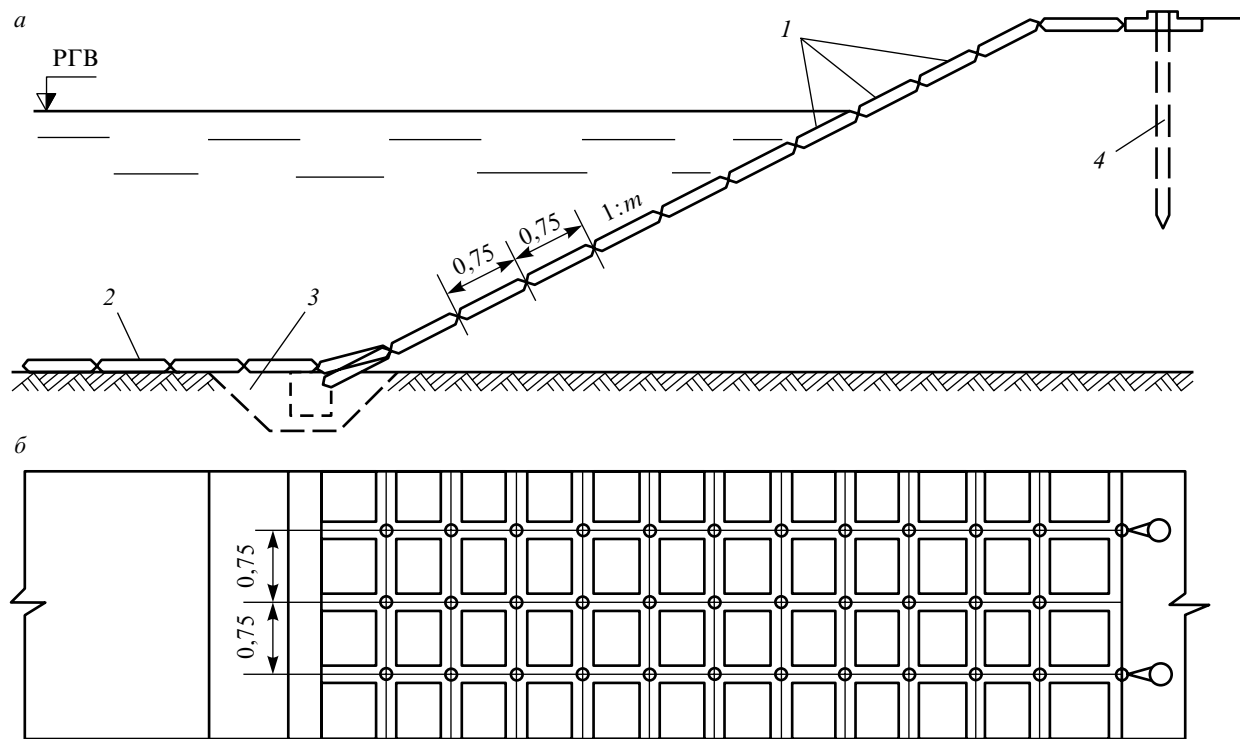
Укрепление откоса гибким плитным покрытием:
